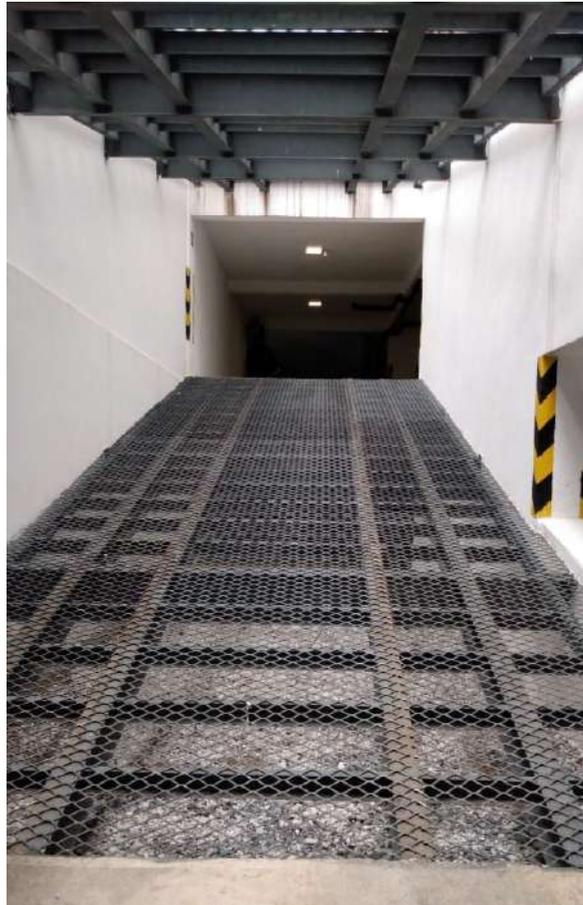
Exemplo de Rampa de Garagem com material vazado.
